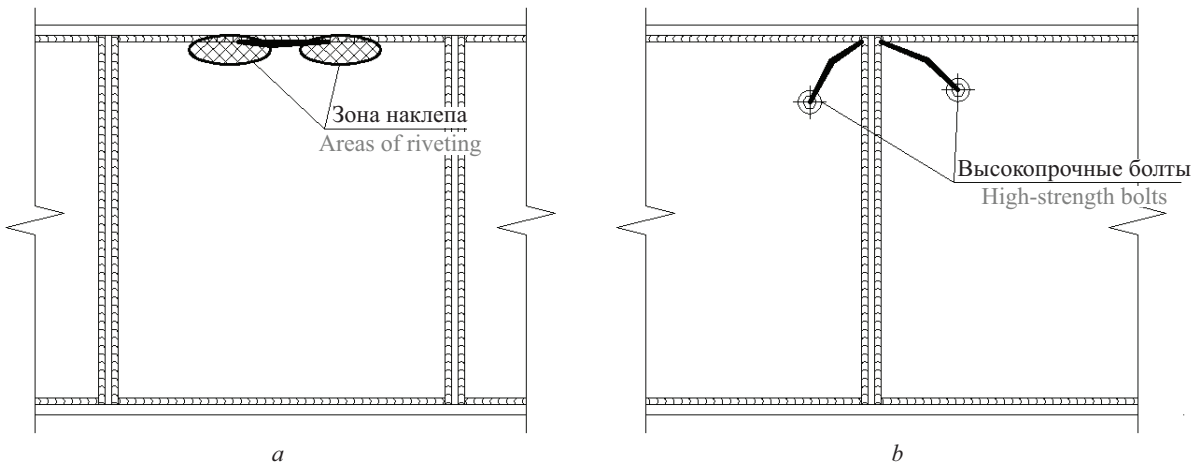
Технологическое торможение развития усталостных трещин в стенке: а — методом наклепа сварного шва; б — засверловкой трещины с постановкой высокопрочного болта
